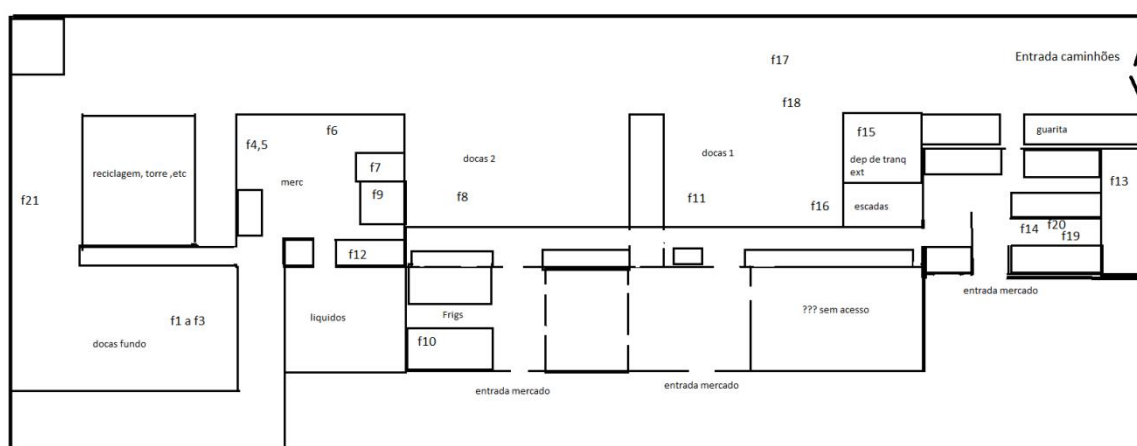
Planta baixa do fundo de loja do hipermercado adotado para estudo.
